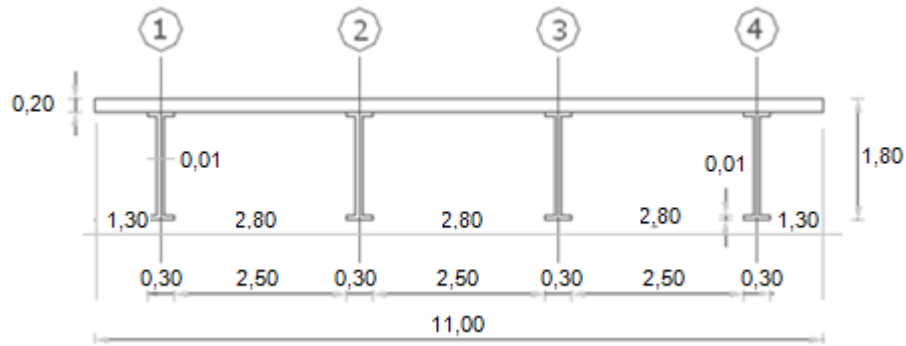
Sección compuesta de vigas longitudinales simplemente apoyadas de acero y tablero de hormigón armado
